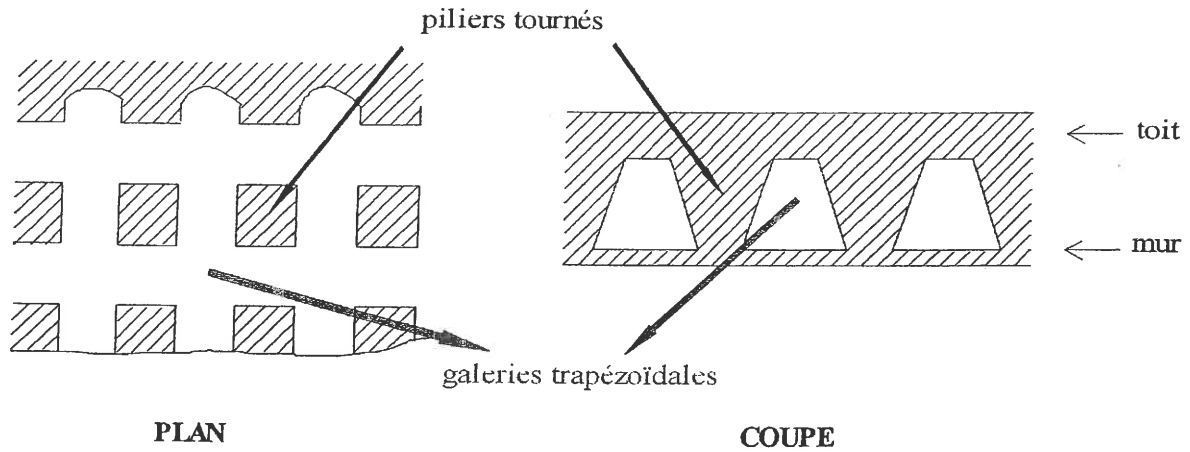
Schéma de l'exploitation par piliers tournés : coupe et plan.
